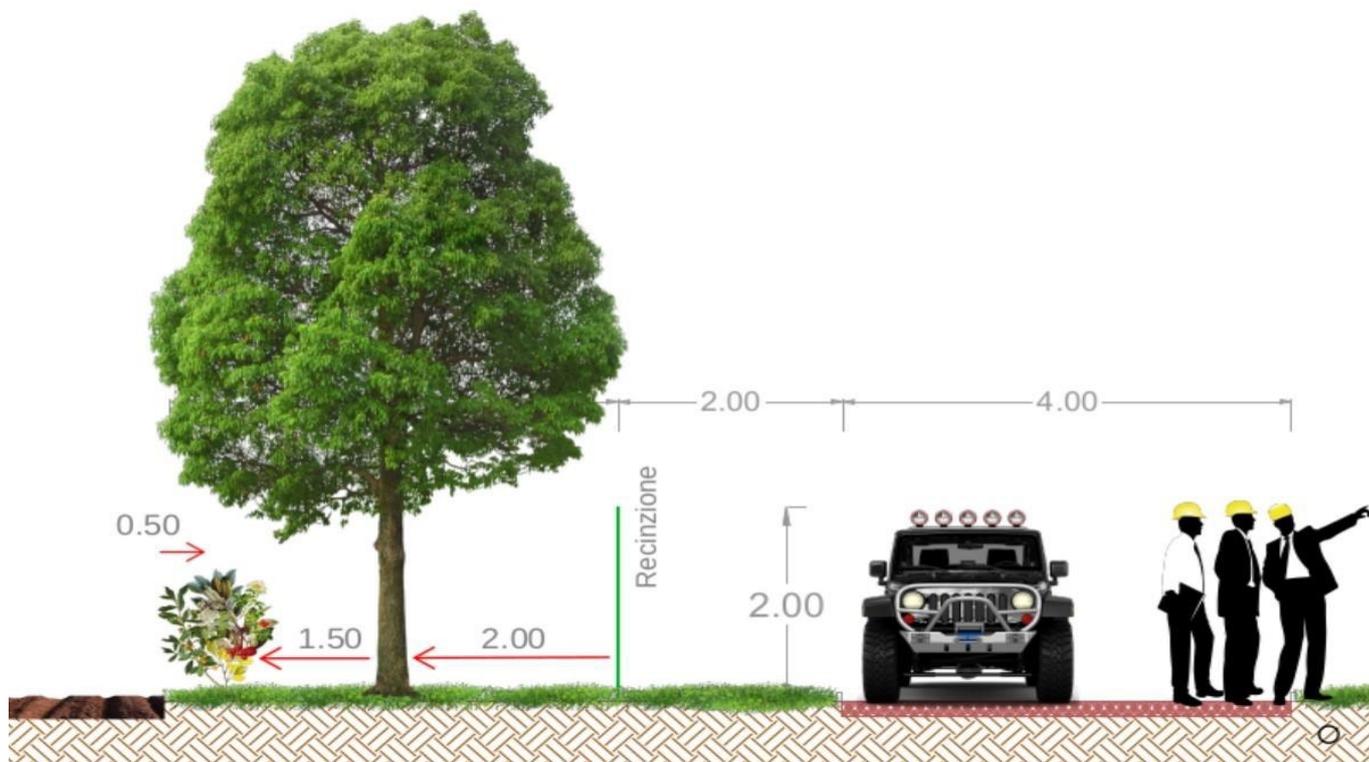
Sezione tipo d'impianto della siepe perimetrale
